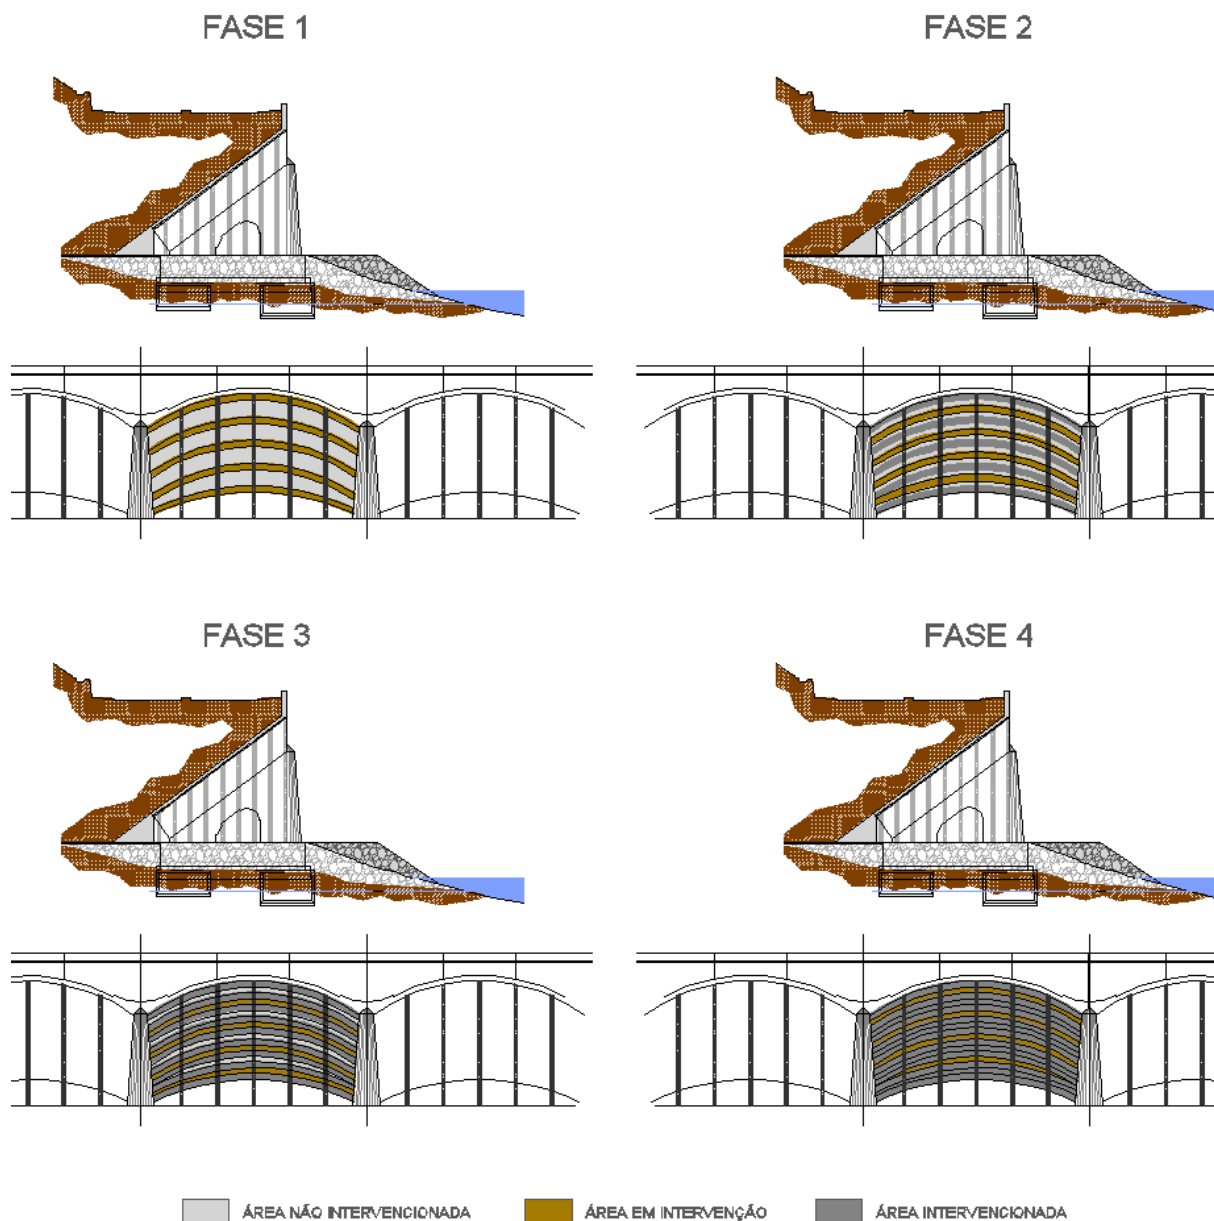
FASEAMENTO CONSTRUTIVO PREVISTO PARA AS ABÓBADAS
